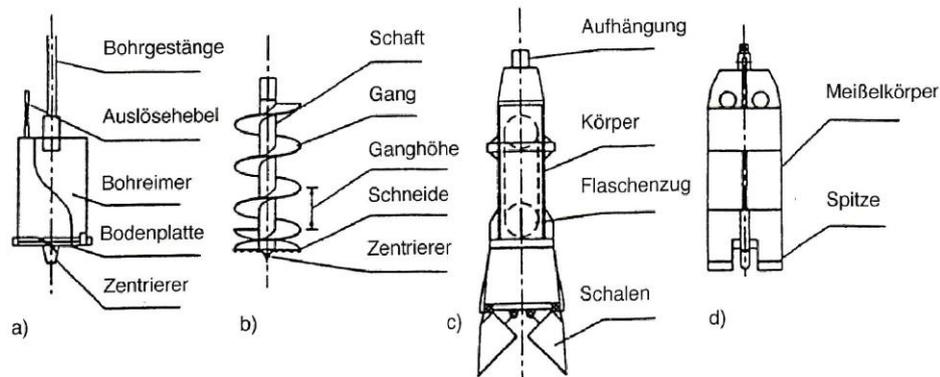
Werkzeuge für diskontinuierlichen Aushub
